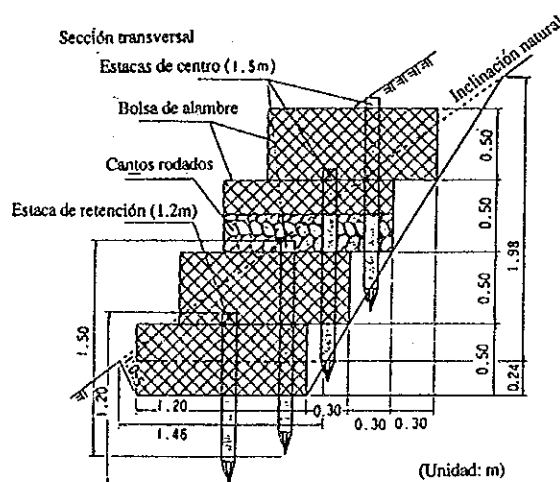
Construcción de trinchos por medio de gaviones de alambre
